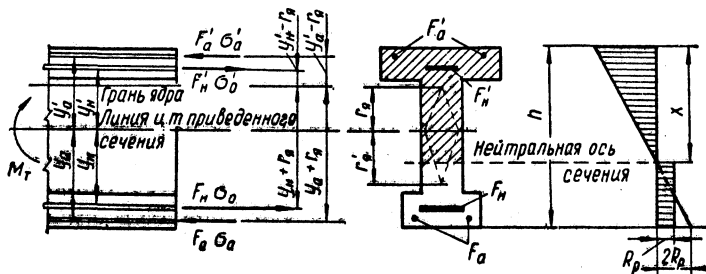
Схема распределения напряжений и усилий в предварительно напряженном железобетонном изгибаемом элементе при расчете трещиностойкости зоны, содержащей арматуру F'_n и F'_a .
